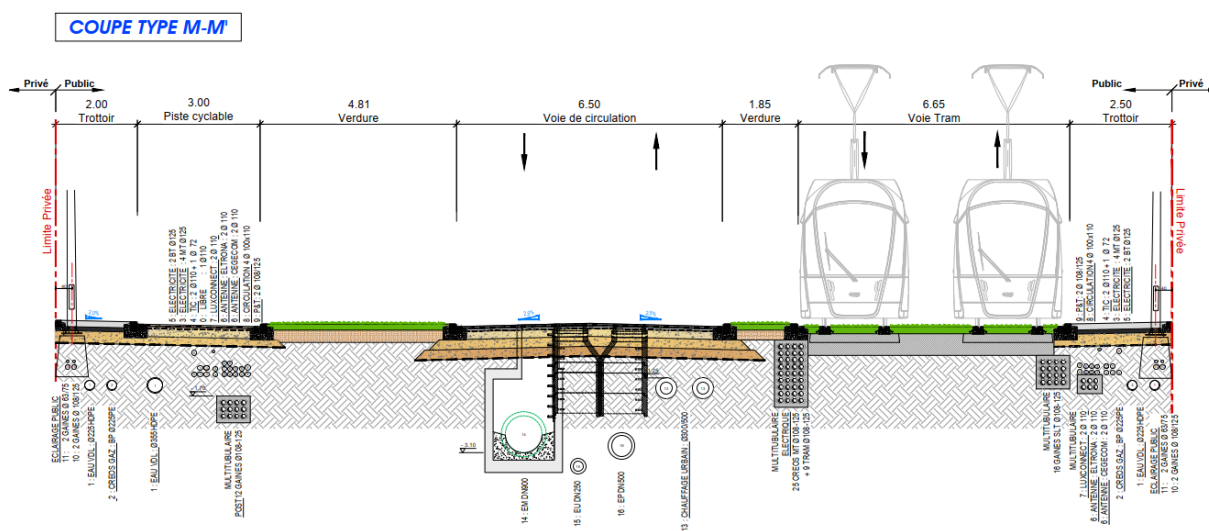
Coupe transversale schématique de la voirie et plateforme tram sur la route d'Arlon. Source : APS - Plans, 2024
